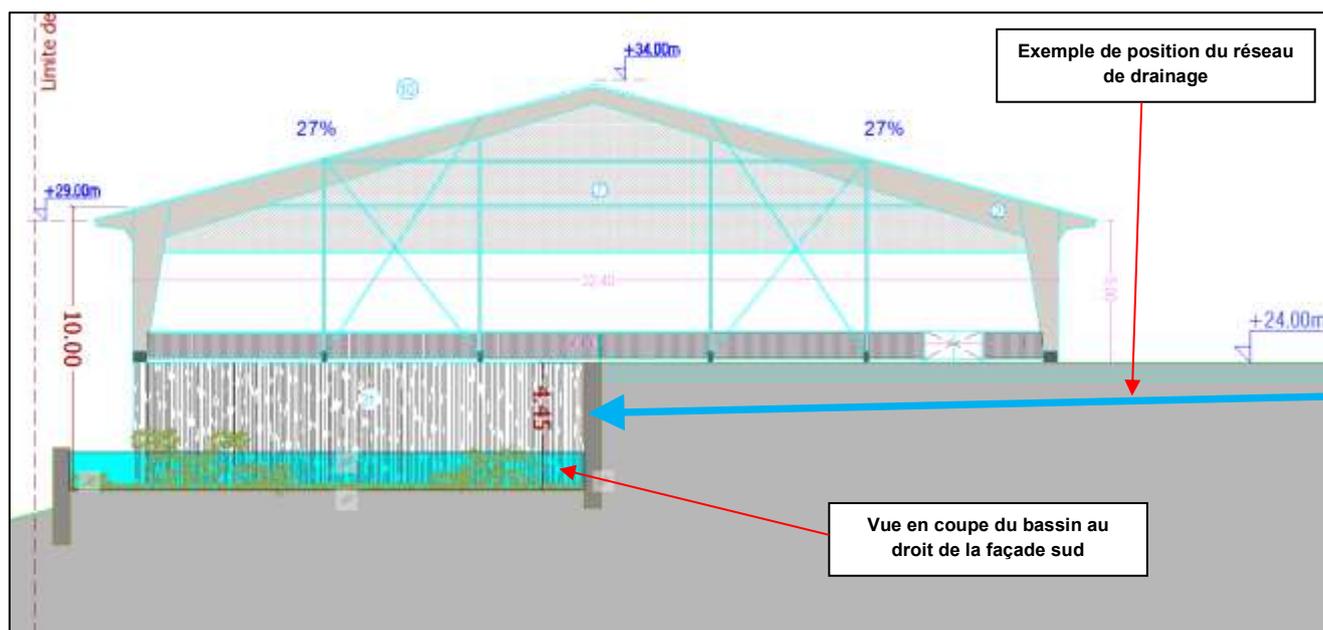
Plan en coupe de principe (vue de la façade sud du hangar)
